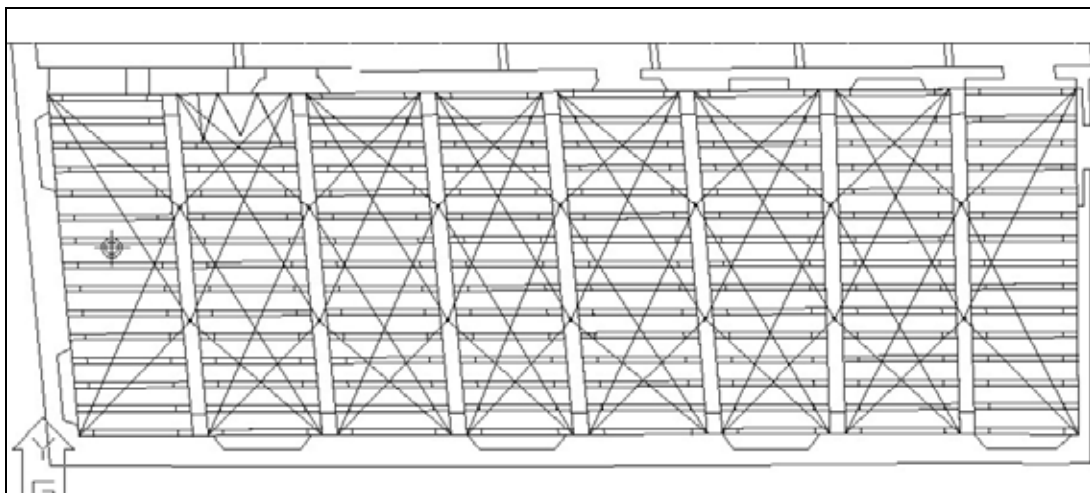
Schema planimetrico della struttura reticolare spaziale
